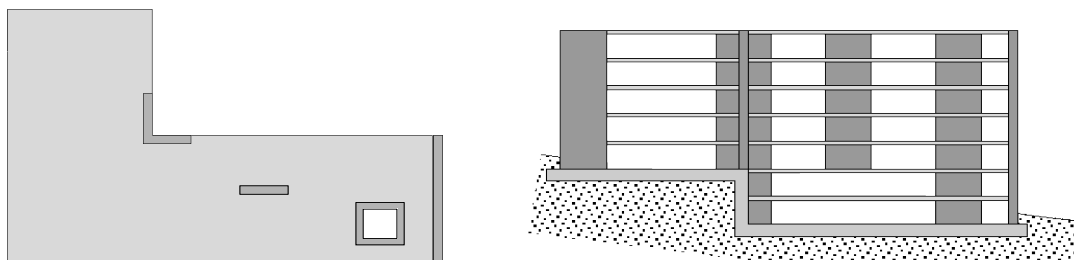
Exemple d'irrégularité prononcée en plan et en élévation, disposition de refends en plan (à gauche) et en élévation (à droite).¹²
